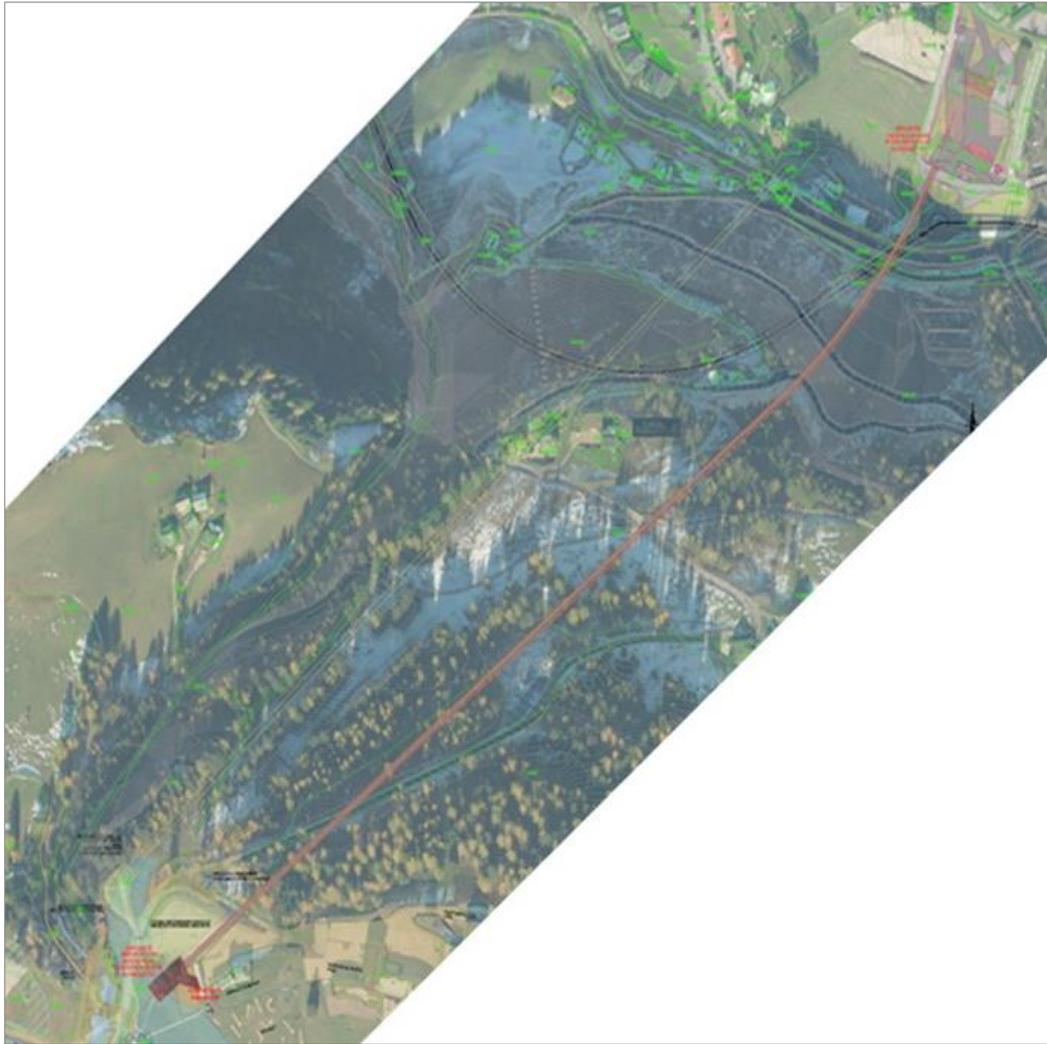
Alternative 1 - ebenfalls Standseilbahn-Lösung ohne unterirdischen Abschnitt
